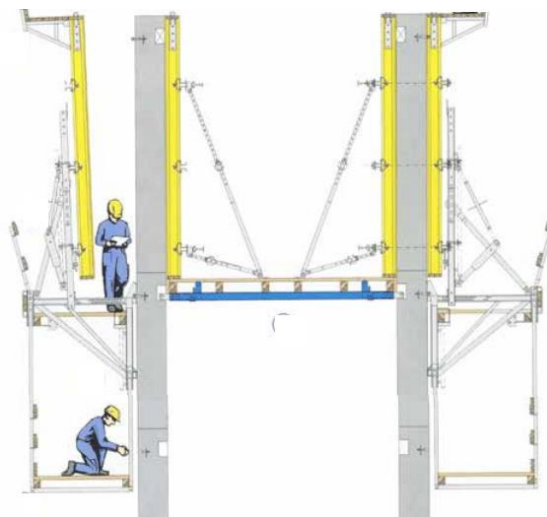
Construcción de columnas con cimbra deslizante. Fuente: Mexpresa
